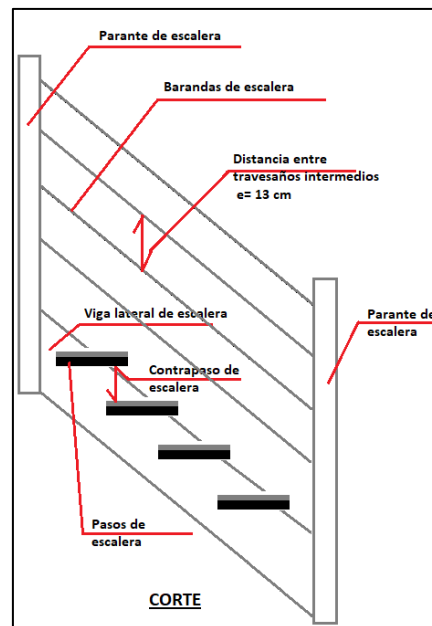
Corte de tramo y barandas de escalera (se aprecian los travesaños y parantes de la baranda).
